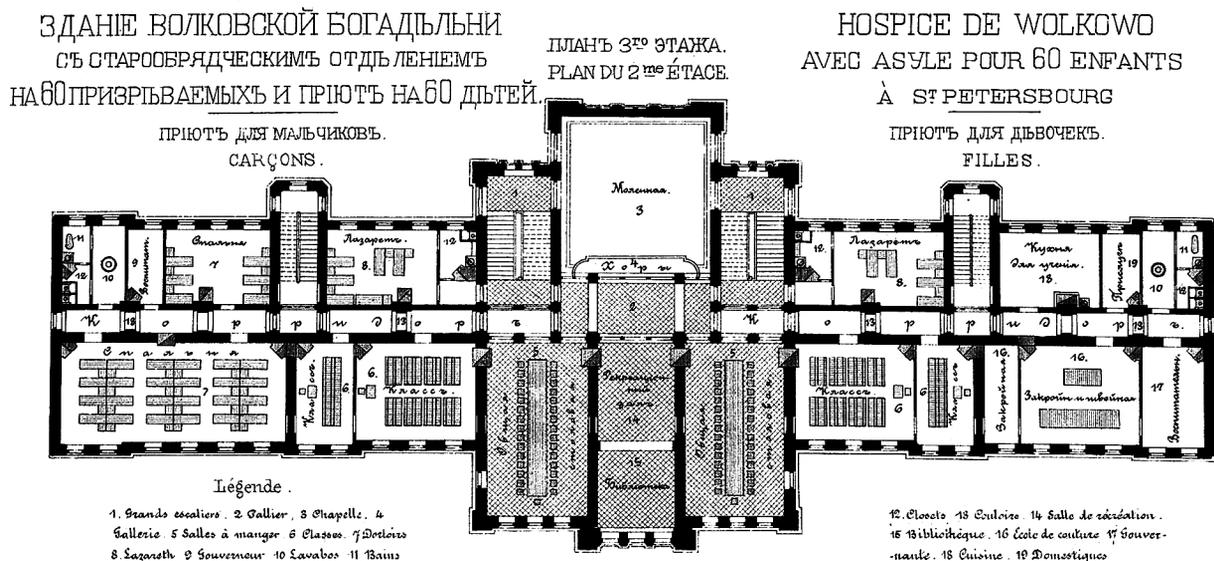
Здание Волковской богадельни. План третьего этажа [9]
